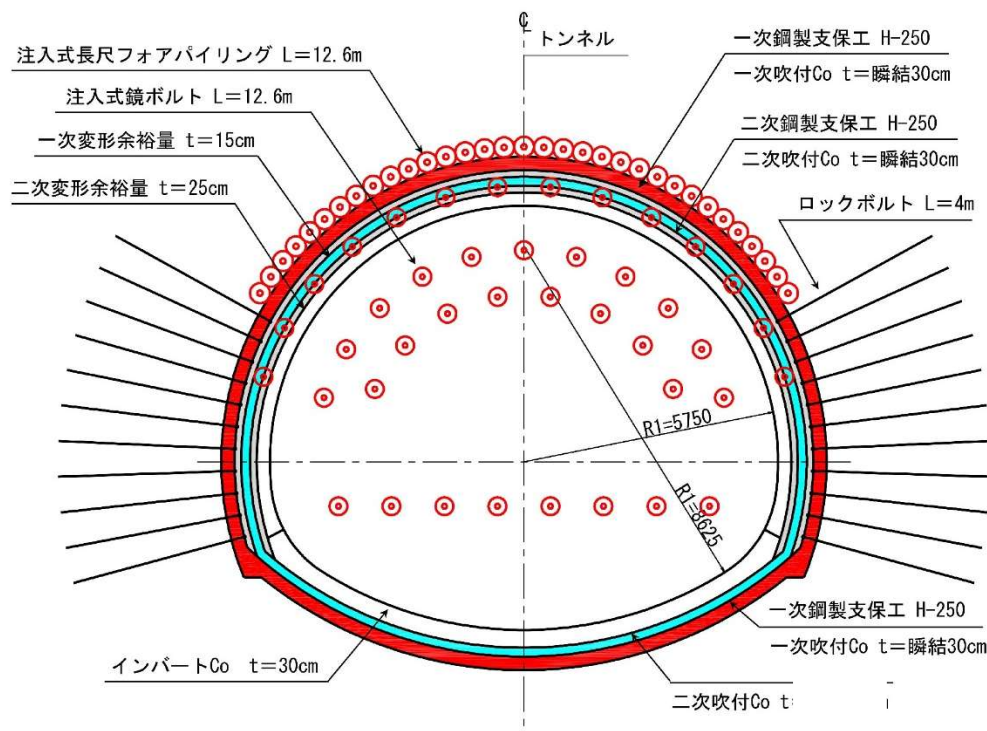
音中トンネル EⅢ (3) 標準断面図
